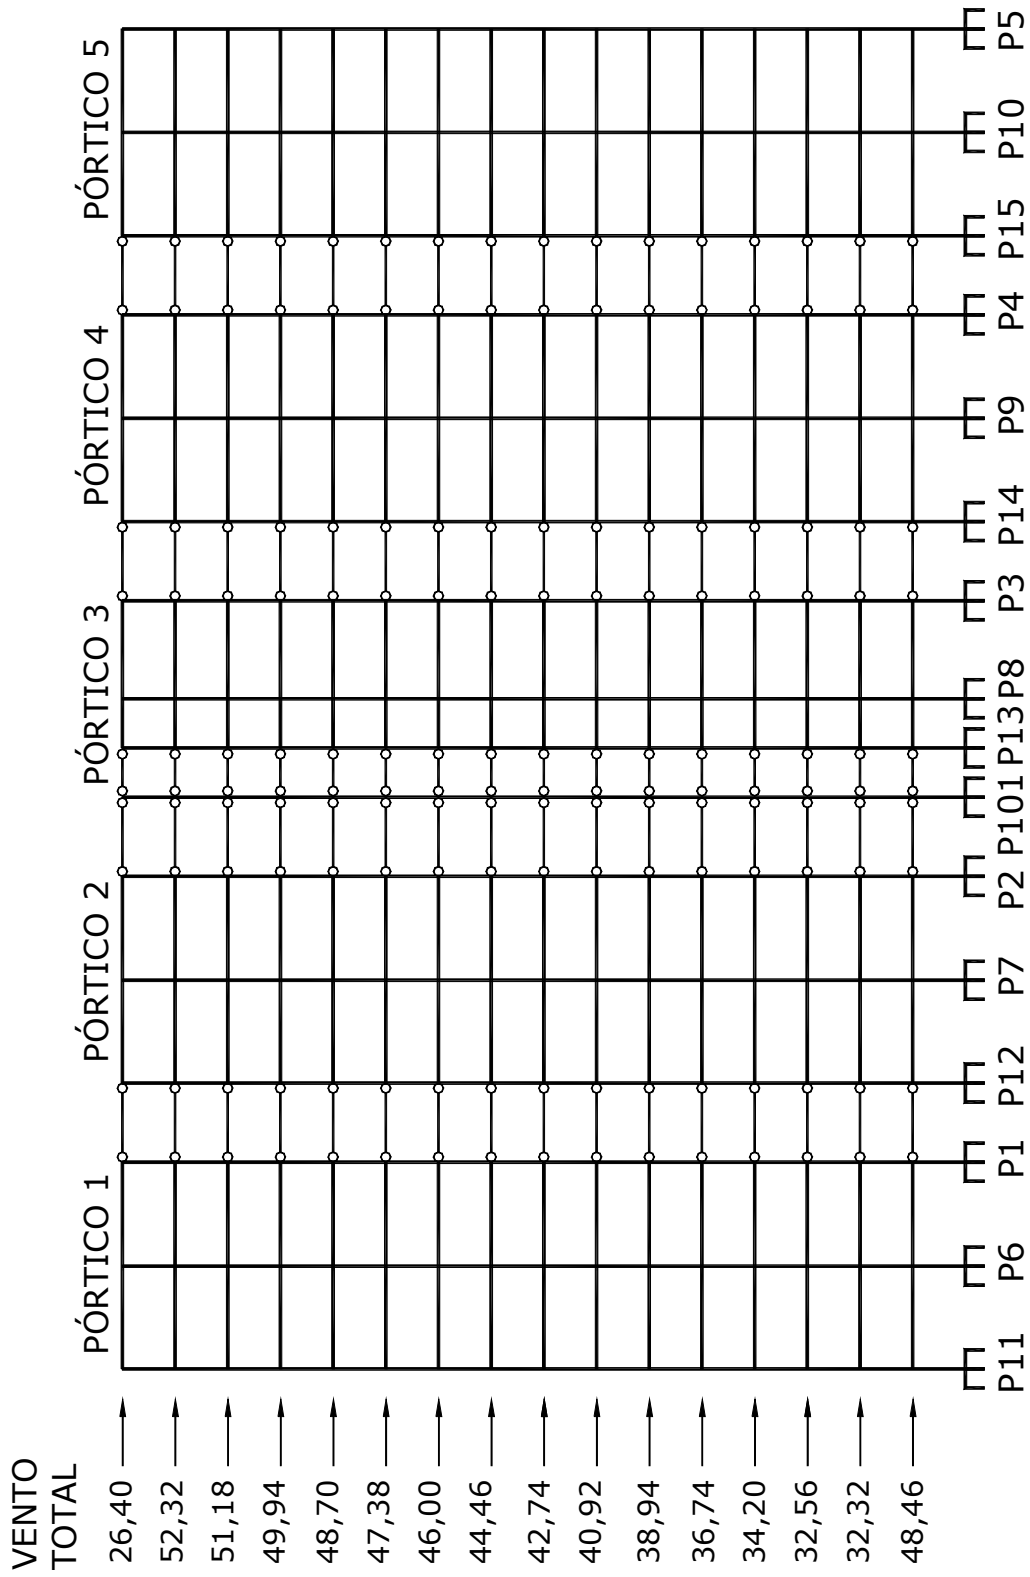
Modelo Pórticos Planos Alinhados (PPA) da Estrutura 3: elevação dos pórticos e esquema do carregamento (em kN).
